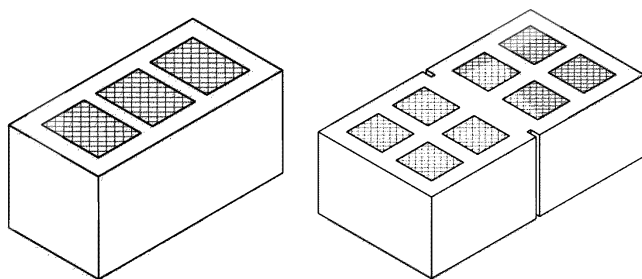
Блоки для кладки стен с термовкладышами
